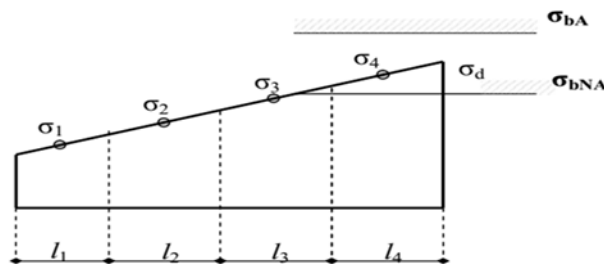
Cas d'un voile de section entièrement comprimé.
